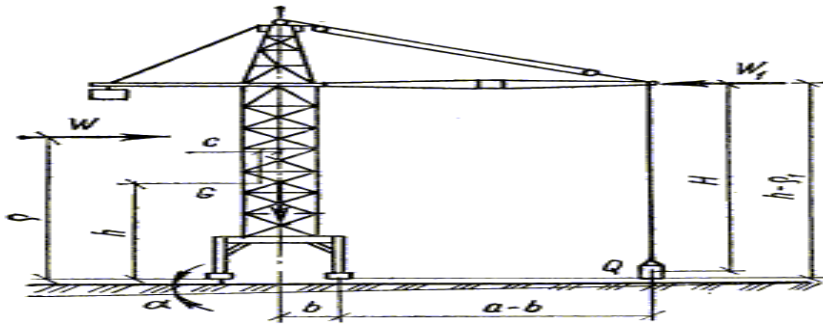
Расчетная схема устойчивости башенного крана с грузом
